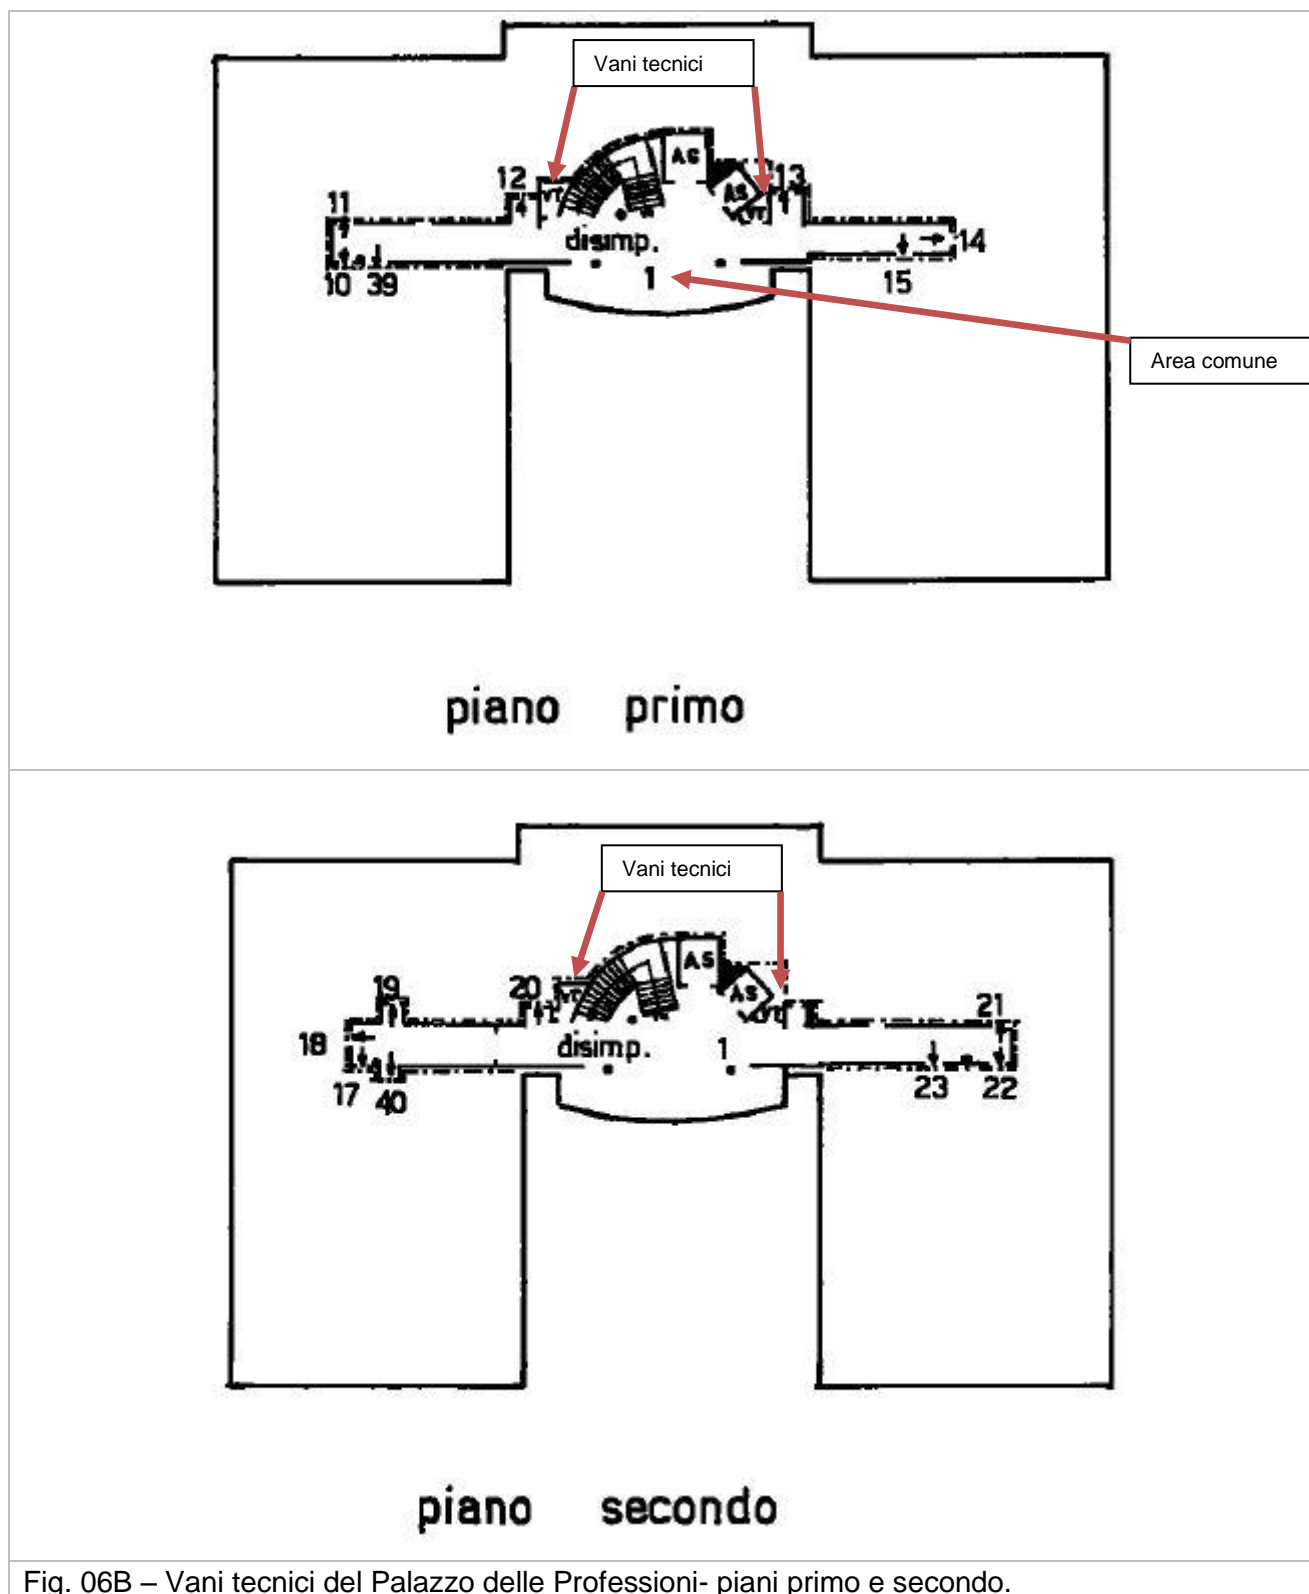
B – Vani tecnici del Palazzo delle Professioni- piani primo e secondo.
